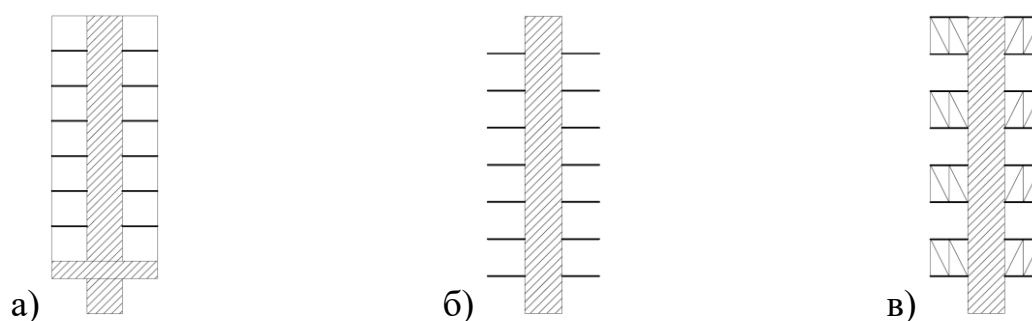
Здания ствольно-консольной конструктивной системы: а) с консольным поясом в уровне нижних этажей; б) с консольными перекрытиями в уровне каждого этажа; в) с консолями высотой на этаж в уровне каждого второго этажа
